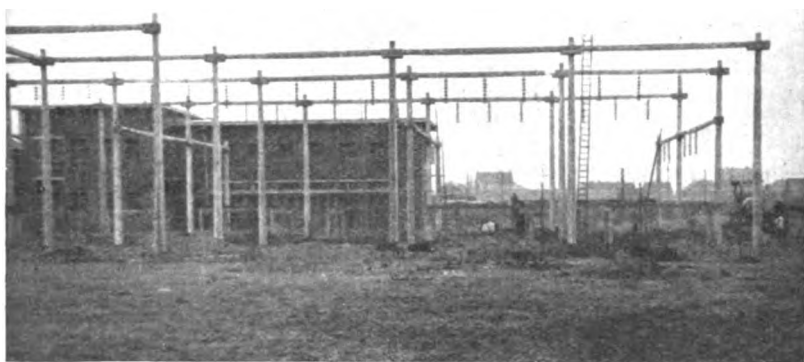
Teilansicht des Schleuderbetongerüsts.
